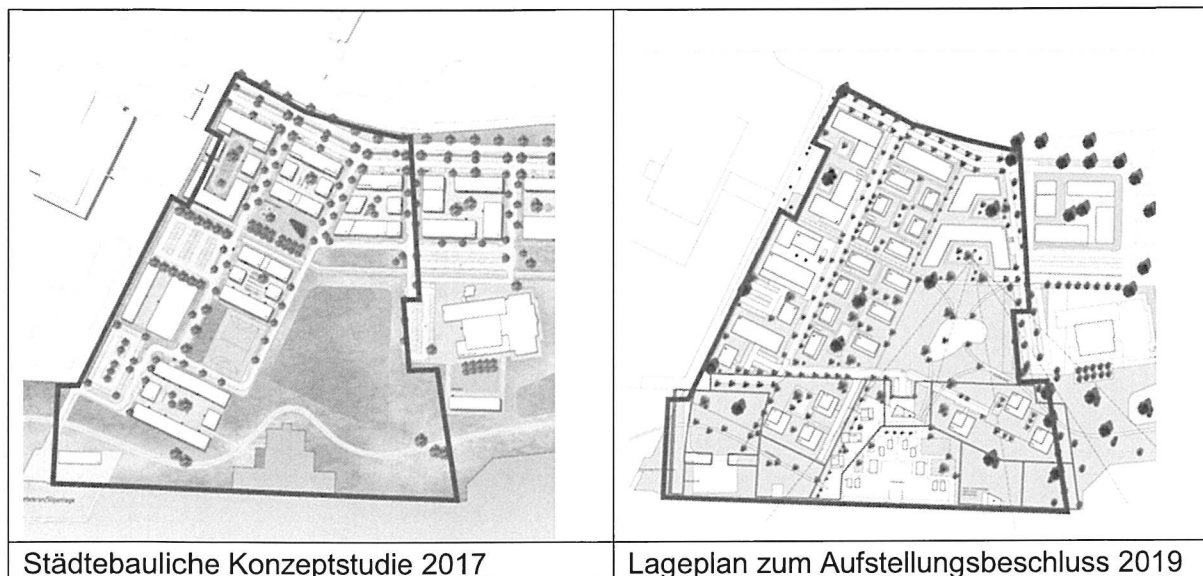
Planungsvarianten Konzeptstudie 2017 und Lageplan Aufstellungsbeschluss 2019
